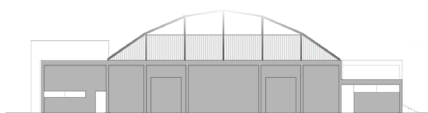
Alzado transversal de TABSA. Difuminado de la cercha como efecto de evaporación. E: 1/750.
